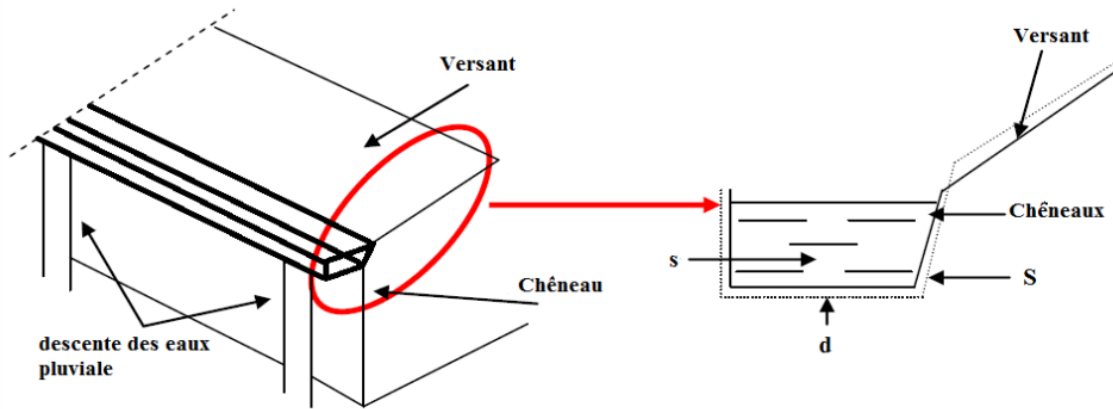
Chéneau d'eau et Coupe transversale du chéneau.
